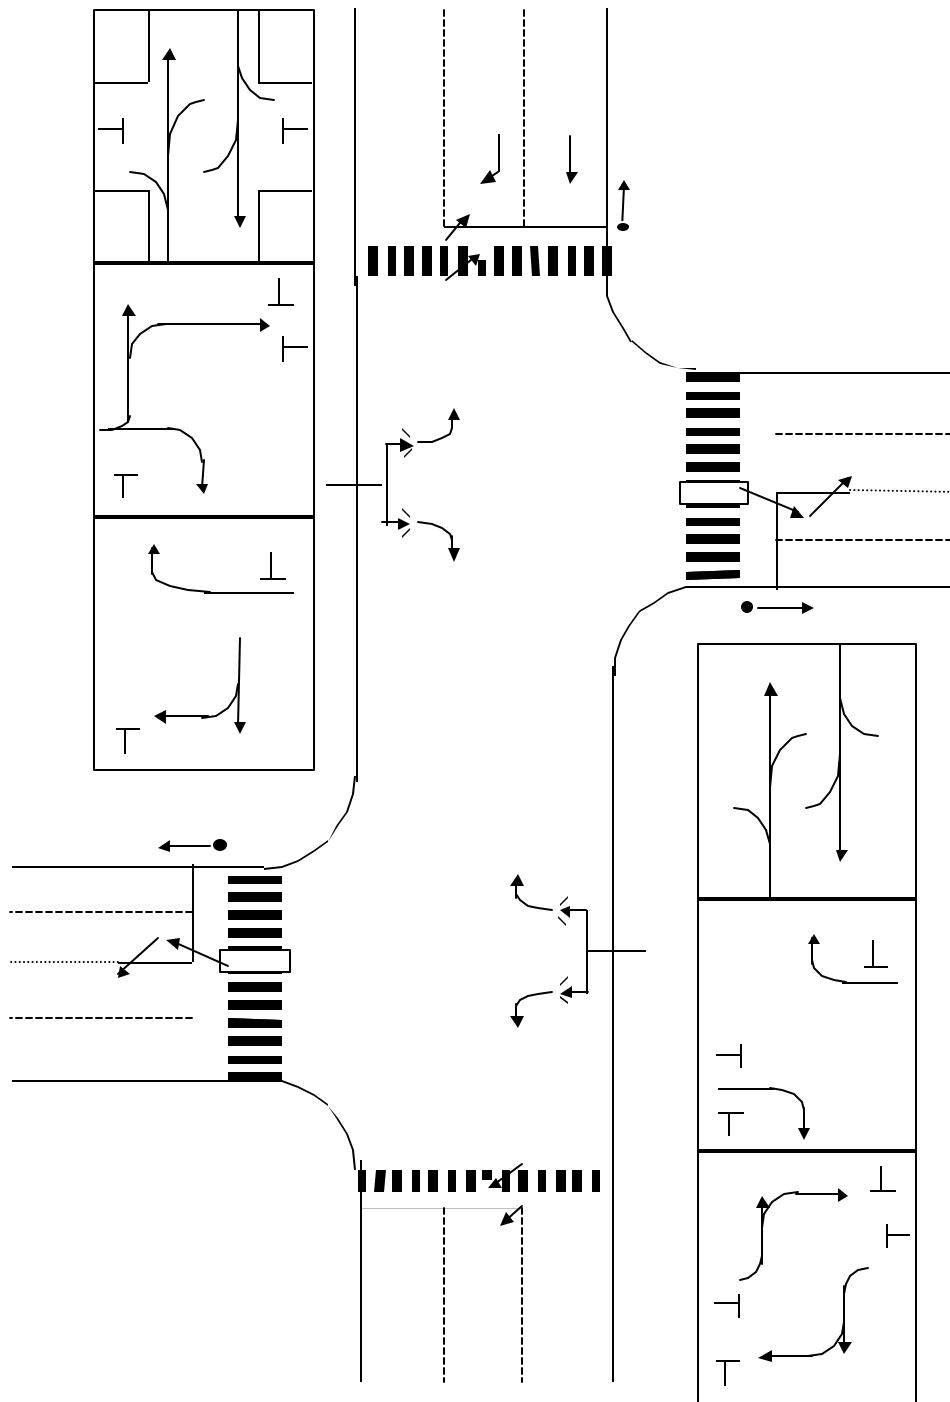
Simpang Empat dengan Jalur Tunggal
